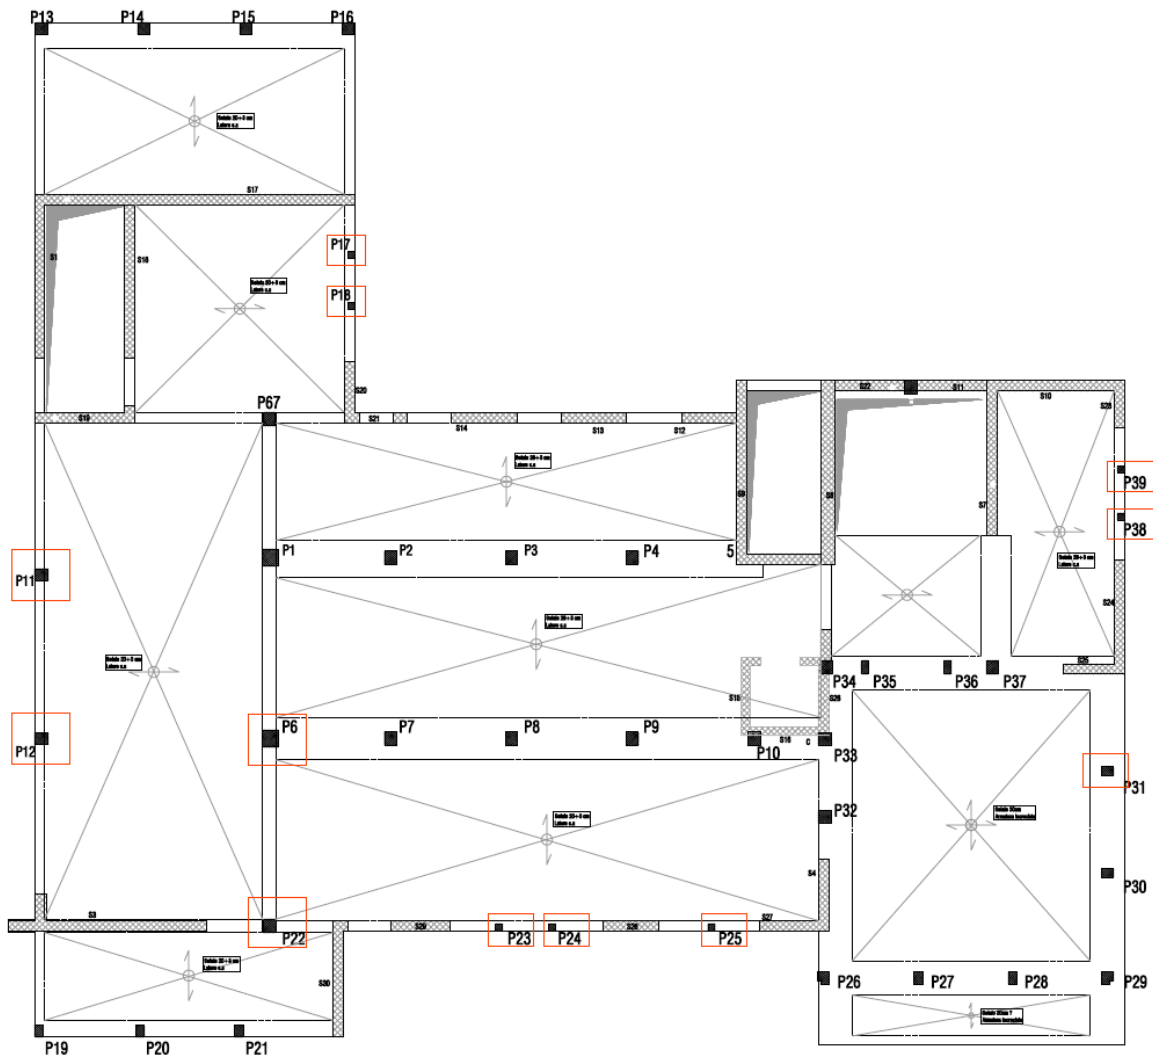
Pilastri piano terra, nel riquadro in rossi pilastri non verificati allo SLU
